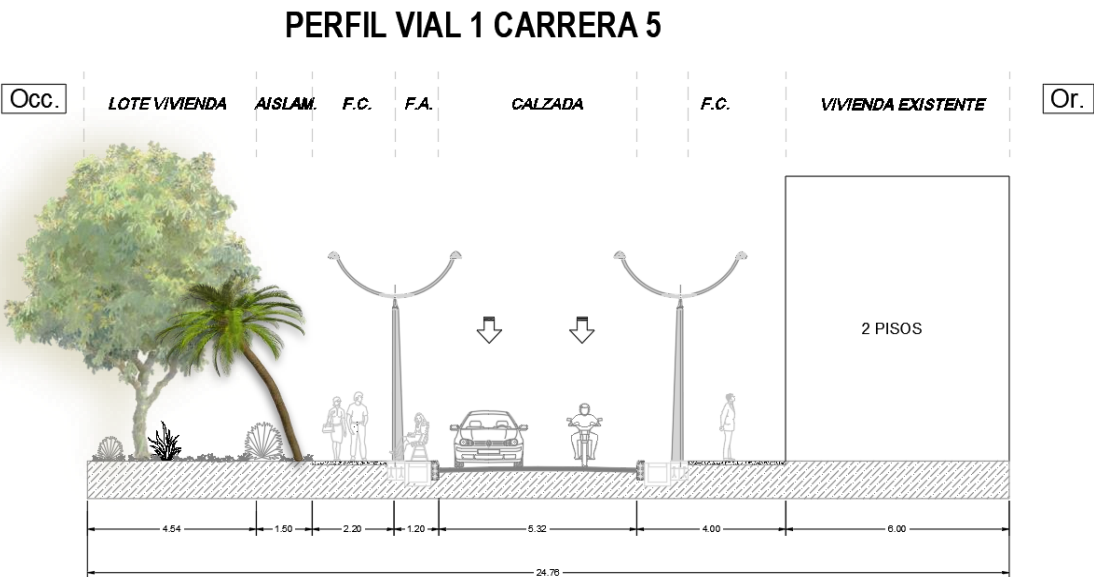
Perfil vial Carrera 5, Cantagallo, Bolívar
